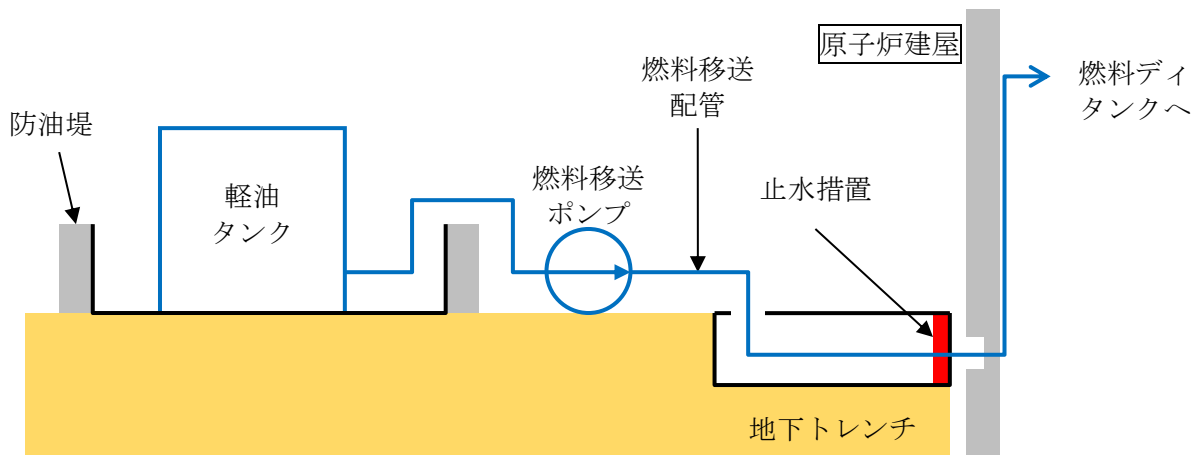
軽油タンク及び関連設備の系統及び設置状況
